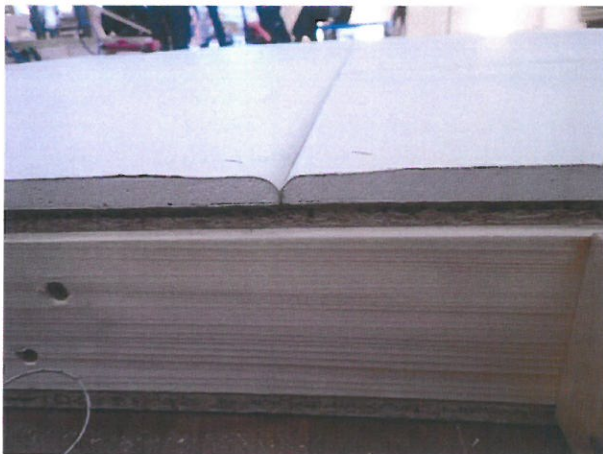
Seitenansicht der Konstruktion mit Variokante der Feuerschutzplatten.
